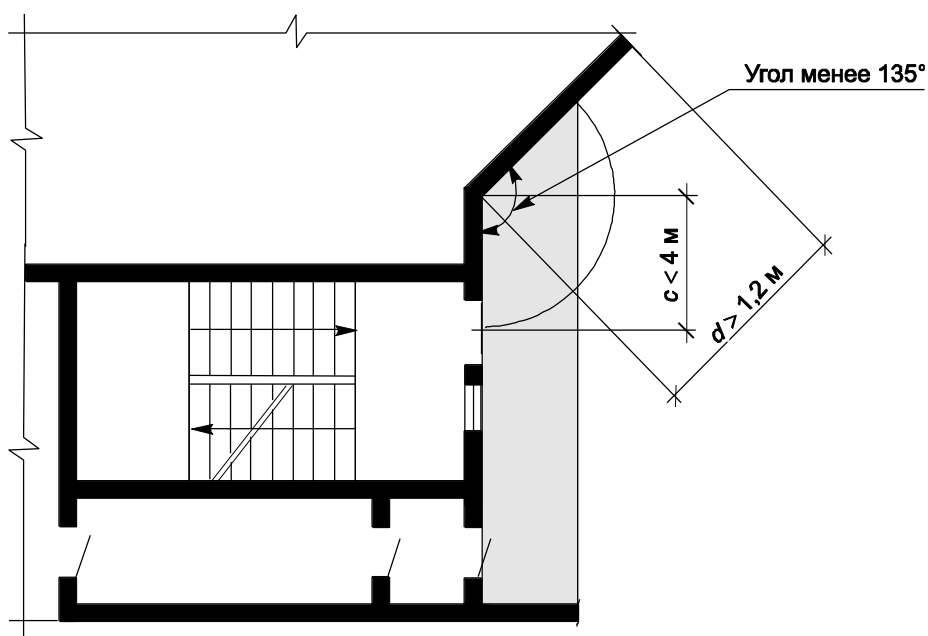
Пример устройства лестничной клетки типа Н1 с вариантом размещения дверей наружной воздушной зоны в плоскостях, расположенных под углом друг к другу
